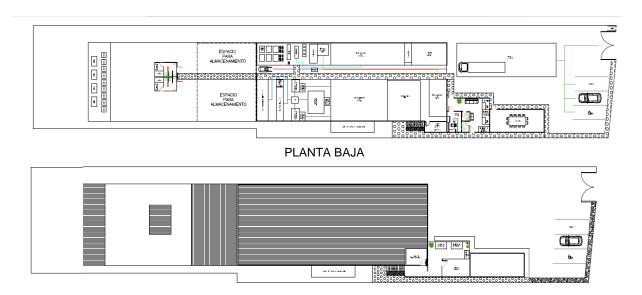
Planta Alta y Planta Baja – Requerimiento del Cliente
